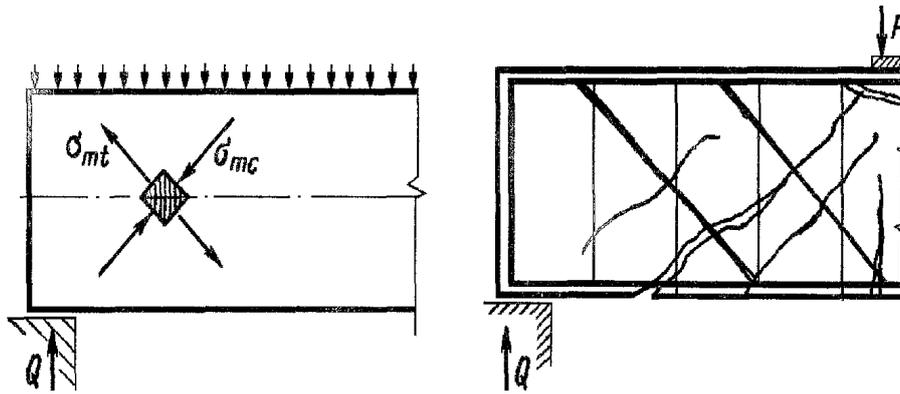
Главные напряжения в бетоне у опоры балки и разрушение изгибаемого элемента по наклонному сечению.
